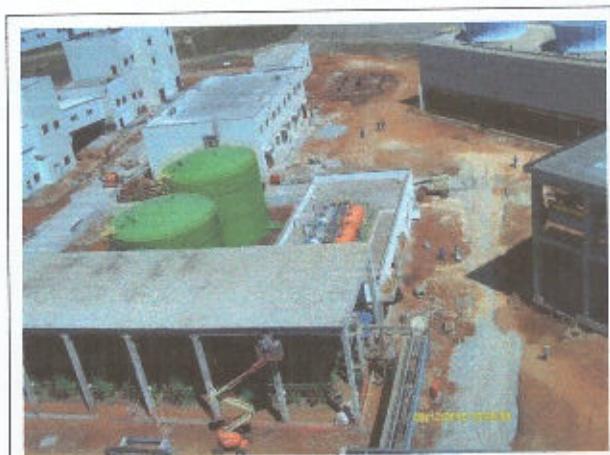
Vias de acesso as Áreas de Abastecimento de produtos químicos - em pavimentação
